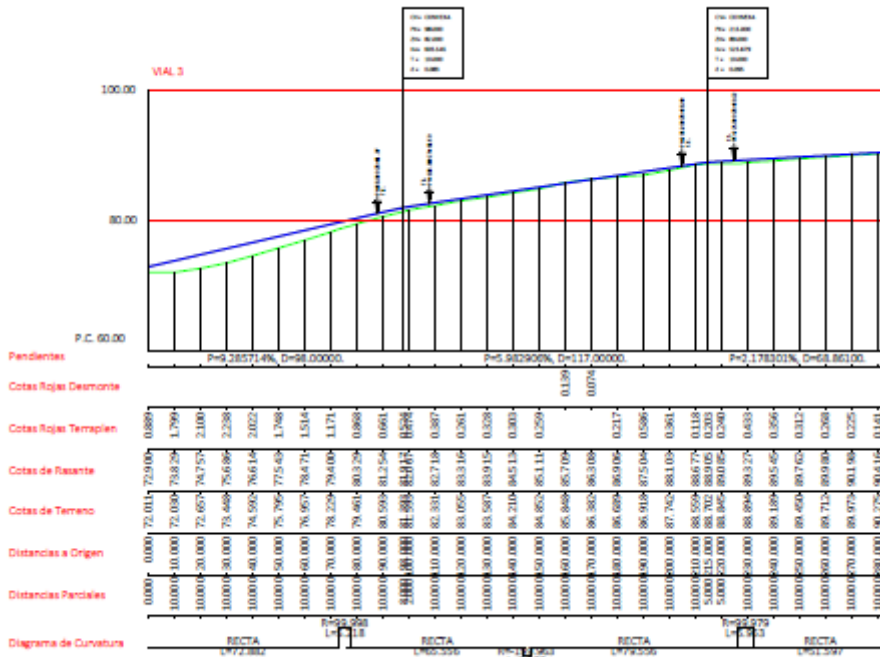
Imagen de la sección longitudinal del vial 3 en la alternativa 2.
